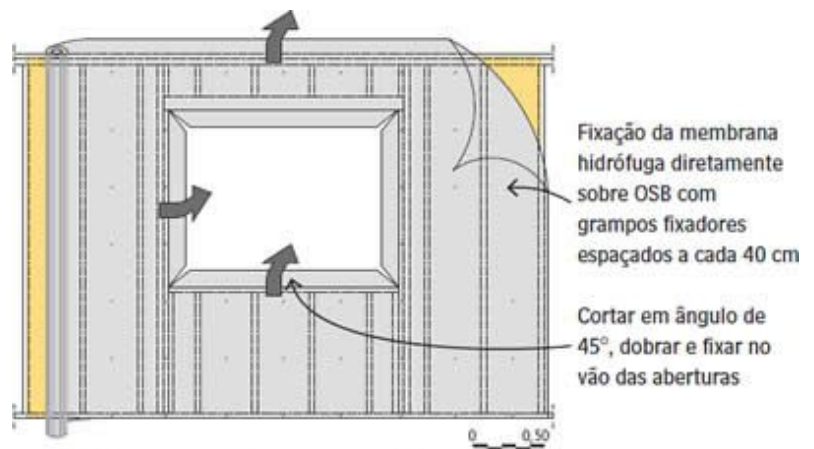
Detalhe da fixação de membrana hidrófuga sobre as chapas de OSB
